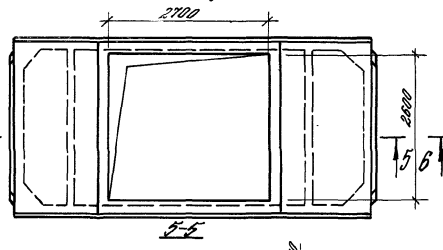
Плита с одним проемом в планке 2600×2700 мм
